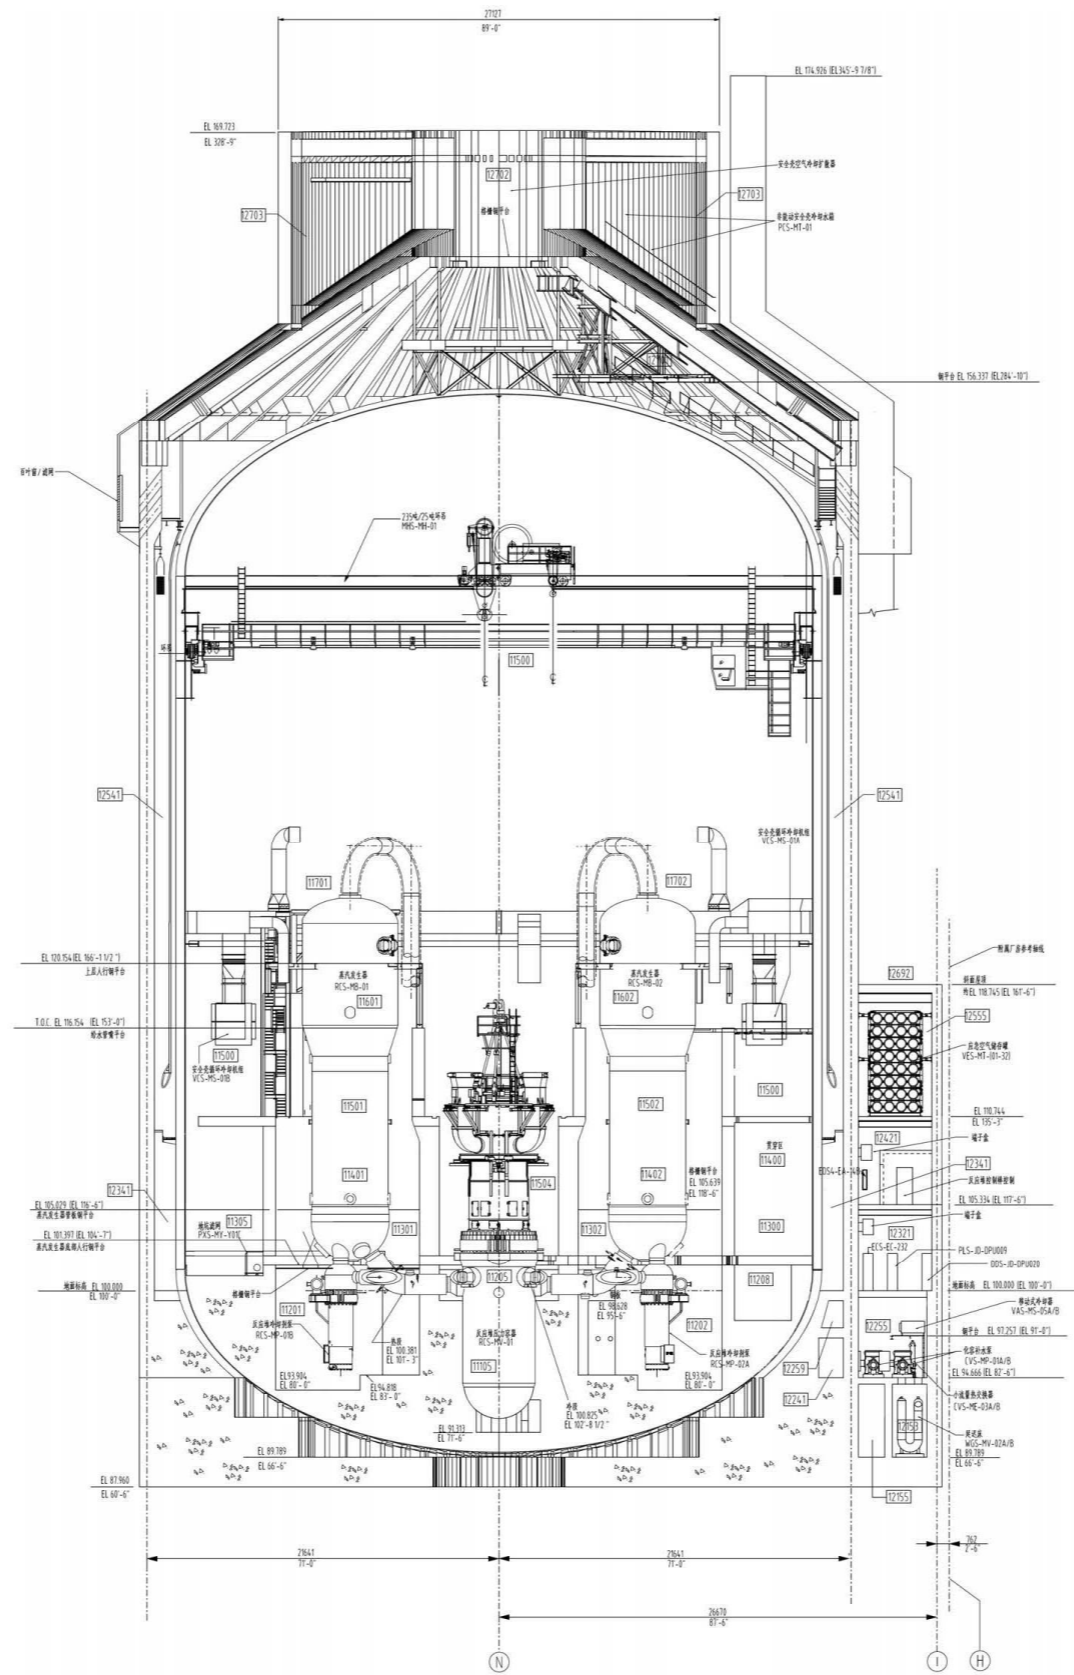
核岛厂房布置示意图 B-B 剖面
